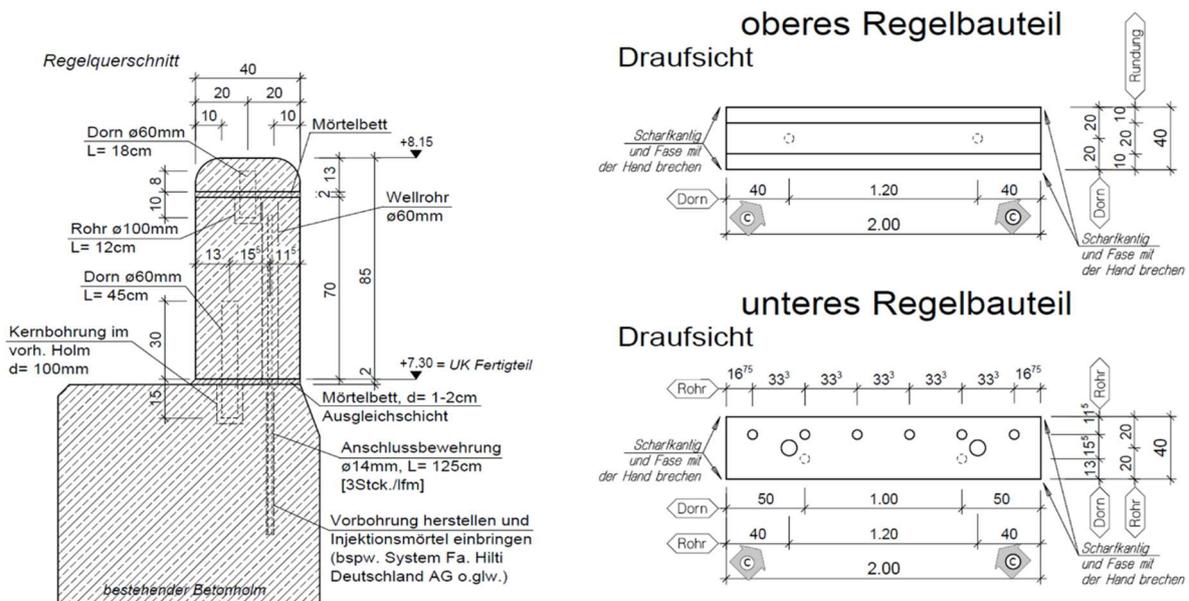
Regelquerschnitt und Draufsicht der Stahlbetonmauer als Sockel mit Deckel, Auszug aus Plan 996/21-1 e der Werkszeichnungen der Stahlbetonfertigteile [U.7]
